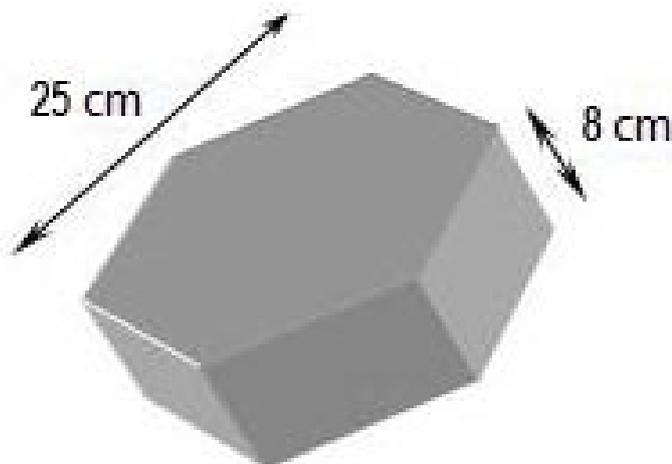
Modelo de Bloquete Sextavado de concreto com extensão de 25cm e espessura de 8cm
